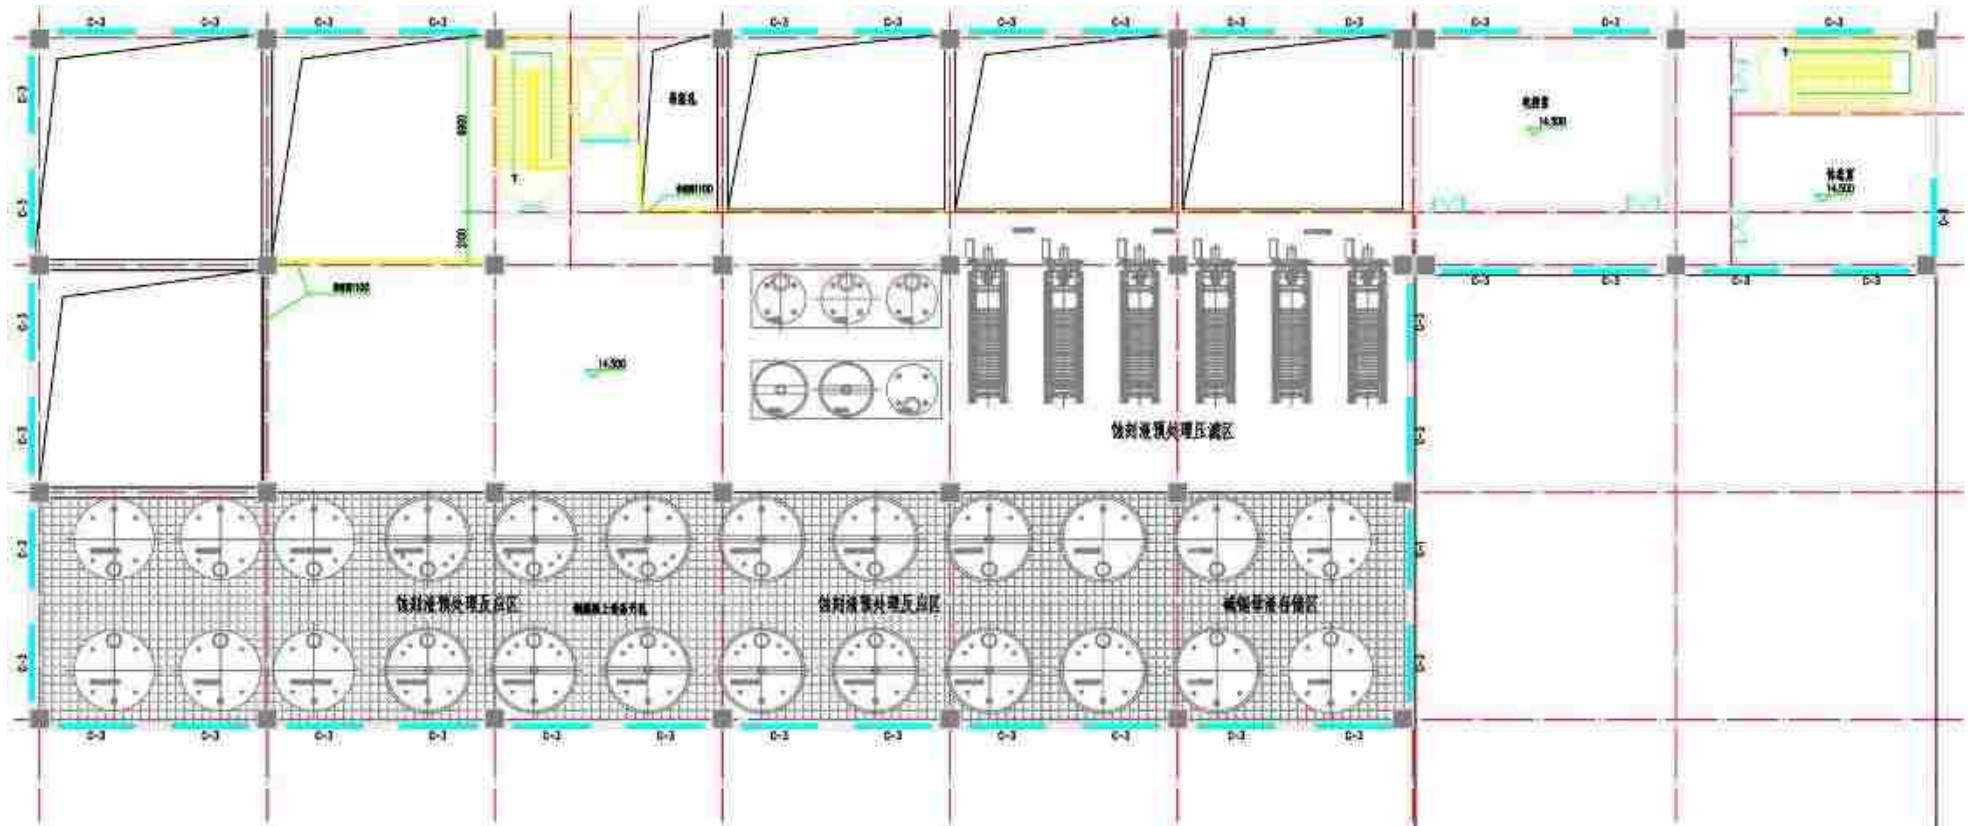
(3) 本次改扩建后 7#\* 厂房 3 层平面布置图
